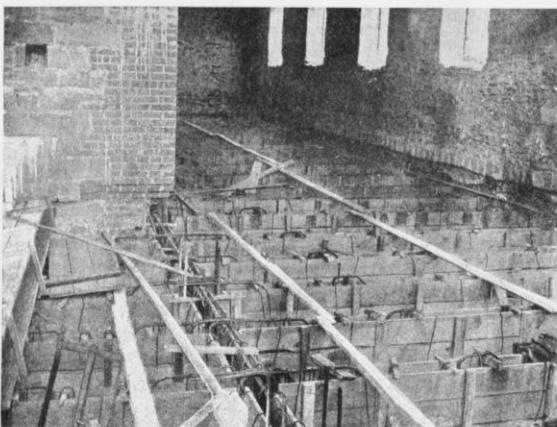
Подвалъ Станції. Снимокъ изображаетъ бродильныя отдѣленія (до устройства раздѣляющихъ ихъ перегородокъ) съ изъѣмомъ демонстрировать устройство желѣзо-бетоннаго перекрытия надъ погребомъ для храненія винъ. На нижнемъ желѣзо-бетонномъ перекрытии подвала (перекрытие двойное съ желѣзо-бетонными же балками между перекрытиями) установленъ рядъ досчатыхъ формъ для желѣзо-бетонныхъ балокъ. Въ формахъ заложены желѣзныя круглого сѣченія стержни съ соотвѣтственнымъ изгибомъ ихъ, мѣстомъ расположения, диаметромъ сѣченія и способомъ соединенія со стержнями нижнаго желѣзо-бетоннаго перекрытия. Отъ кирпичнаго угла къ зрителю расположена форма для основной поперечной желѣзо-бетонной балки, несущей нагрузку отъ ряда балокъ и покоящейся на двухъ желѣзо-бетонныхъ колоннахъ въ погребѣ.
